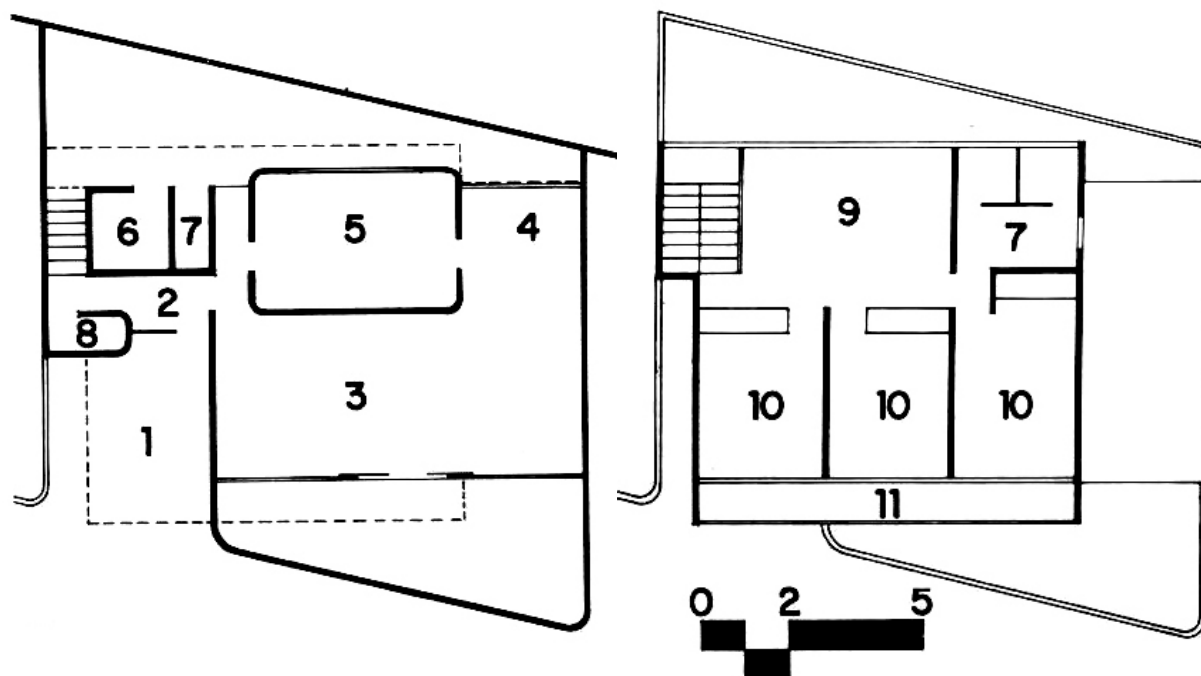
Conjunto Residencial Silva Jardim; planta pavimento térreo: 1) garagem; 2) hall de acesso; 3) sala social; 4) refeições; 5) cozinha; 6) Q. empregada; 7) banho; 8) lavabo.
